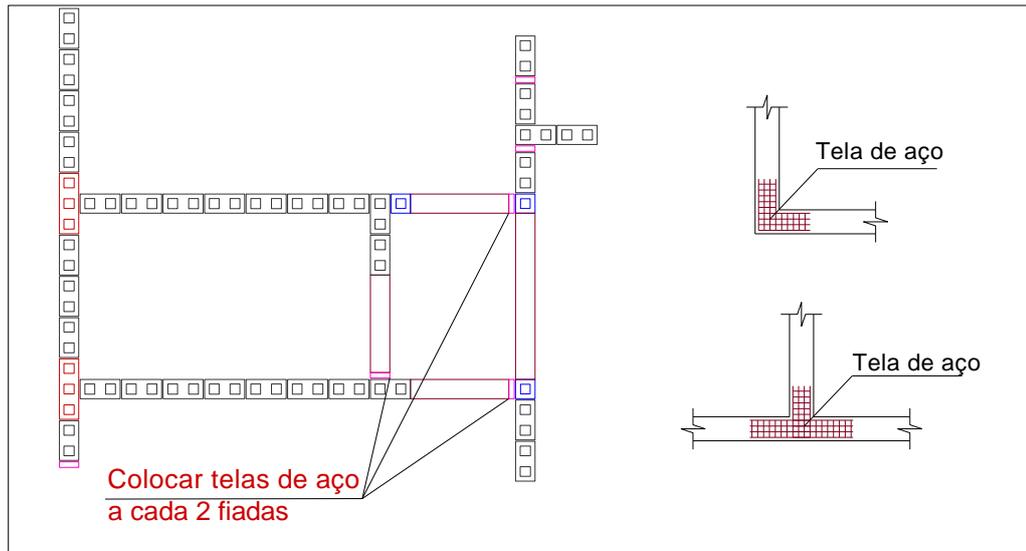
Detalhe das amarrações indiretas utilizada nas portas de canto.
